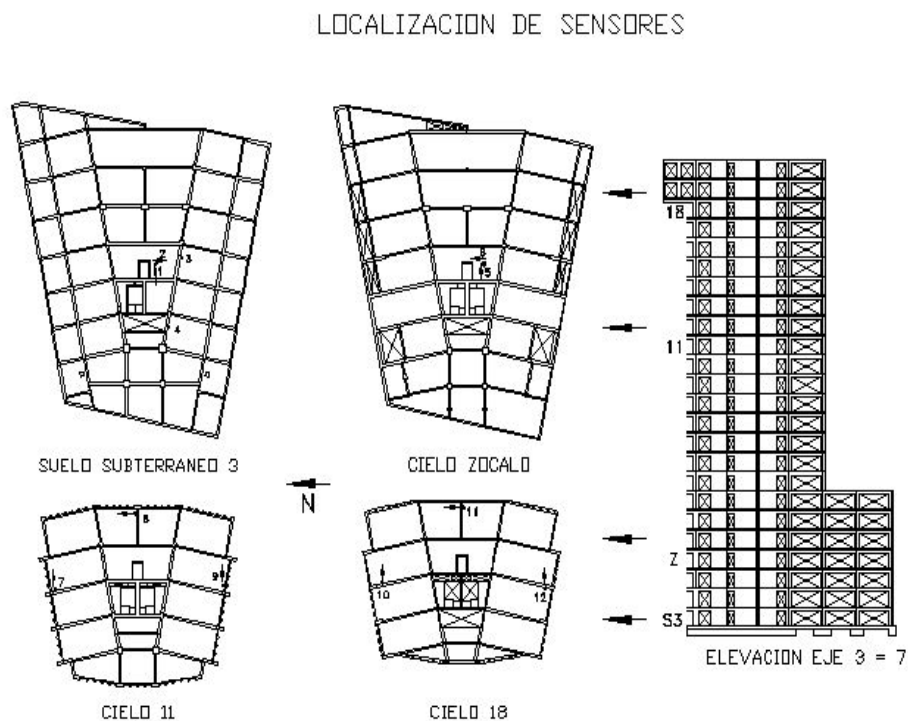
Edificio de la Cámara Chilena de la Construcción
